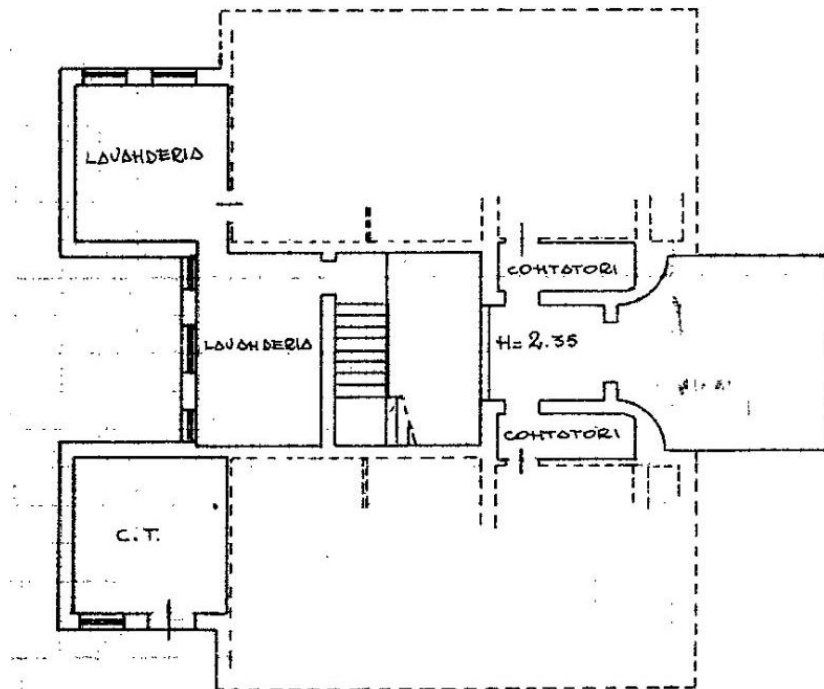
Estratto planimetria catastale parti comuni piano terra.
